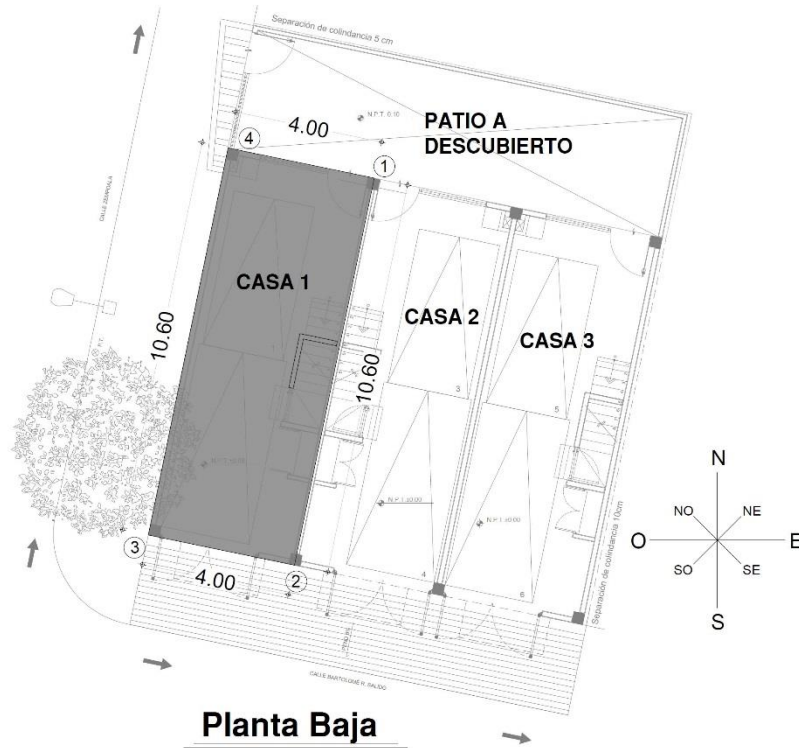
Esquema arquitectónico, Planta Baja Casa 1, estacionamiento.
